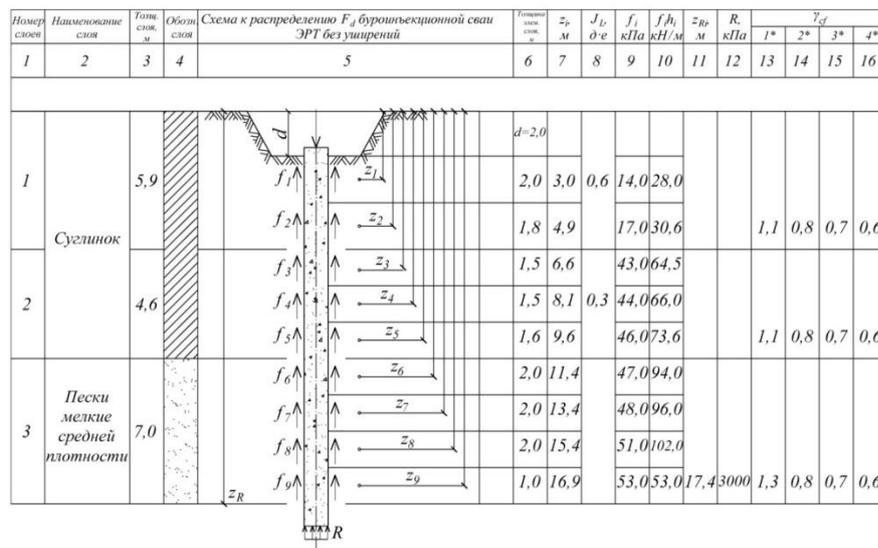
Схема к определению несущей способности F_d буровых свай. Примечания: 1* – Для буровьекционных свай-ЭРТ без промежуточных уширений; 2* – Для буронабивных свай при погружении инвентарной трубы с теряемым наконечником; 3* – Для буронабивных свай с использованием обсадных труб или проходных шнеков; 4* – Для буронабивных свай, выполняемых под защитой глинистой рубашки. Коэффициенты γ_{cf} взяты из табл. 7.6 СП 24.13330.2021.
